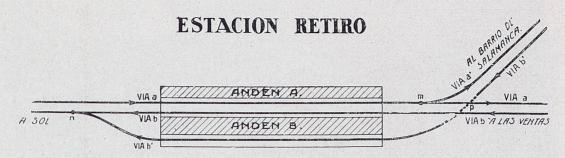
Croquis de la disposición general de la Éstación del Retiro.
